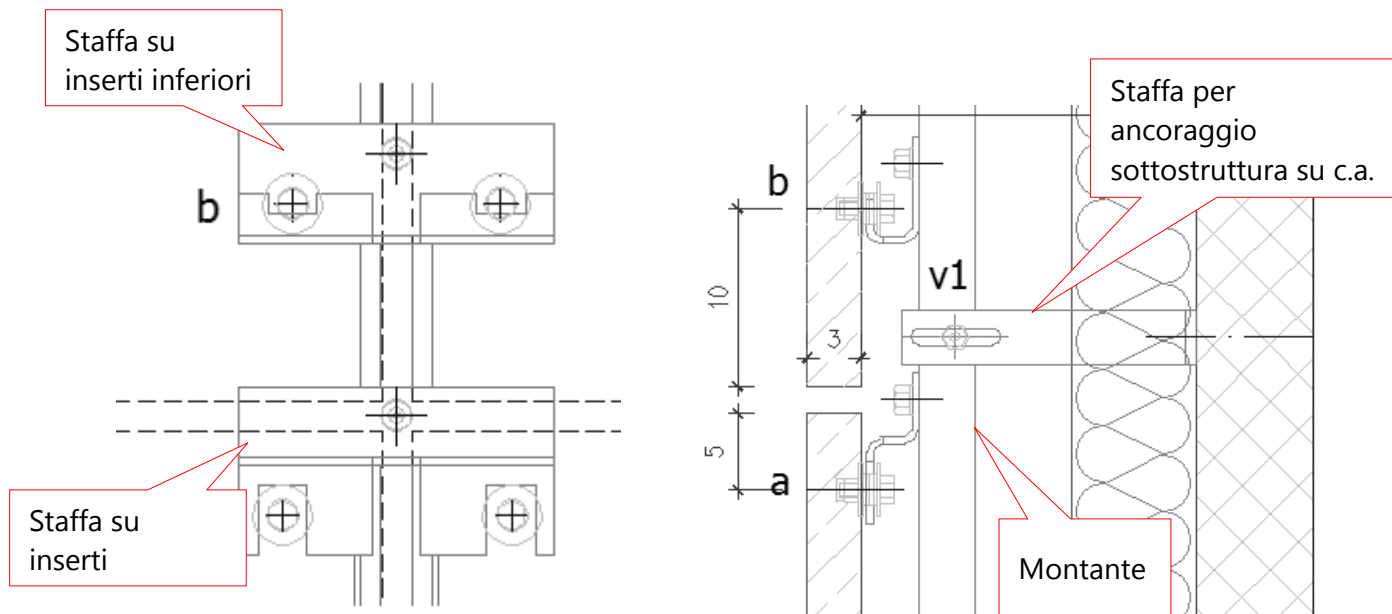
Dettaglio 1 ancoraggio lastra su sottostruttura in acciaio. Prospetto e sezione tipo (SDF)
